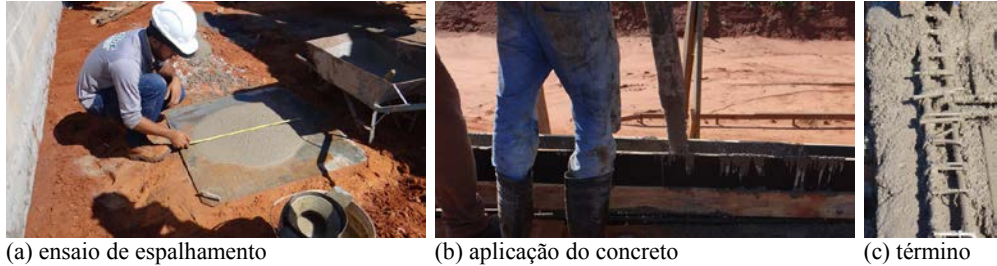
Detalhes do concreto CAA6,3B sendo aplicado na concretagem das paredes.
